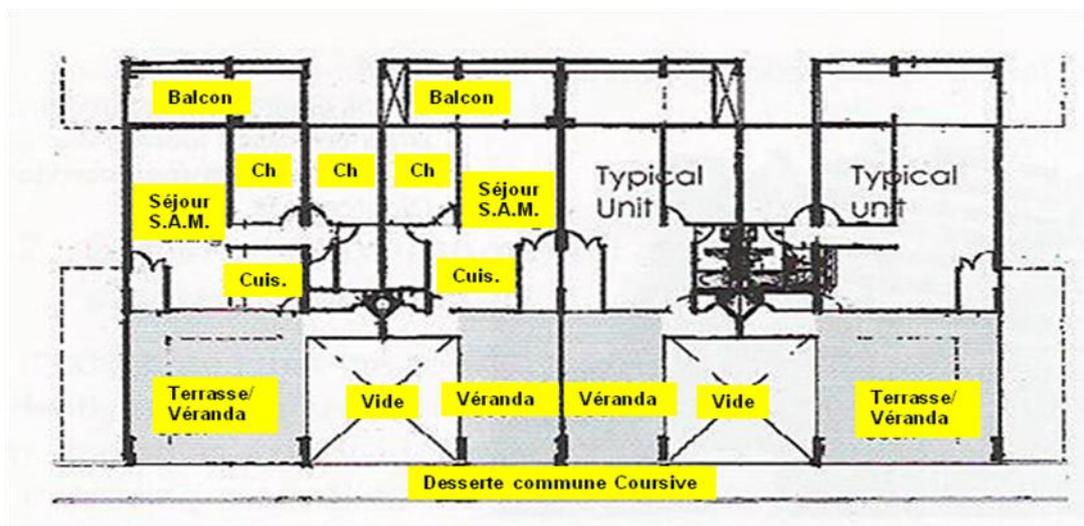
Plan d'un étage courant de Bedok Court : espaces extérieurs sur les deux façades, d'après (11).
